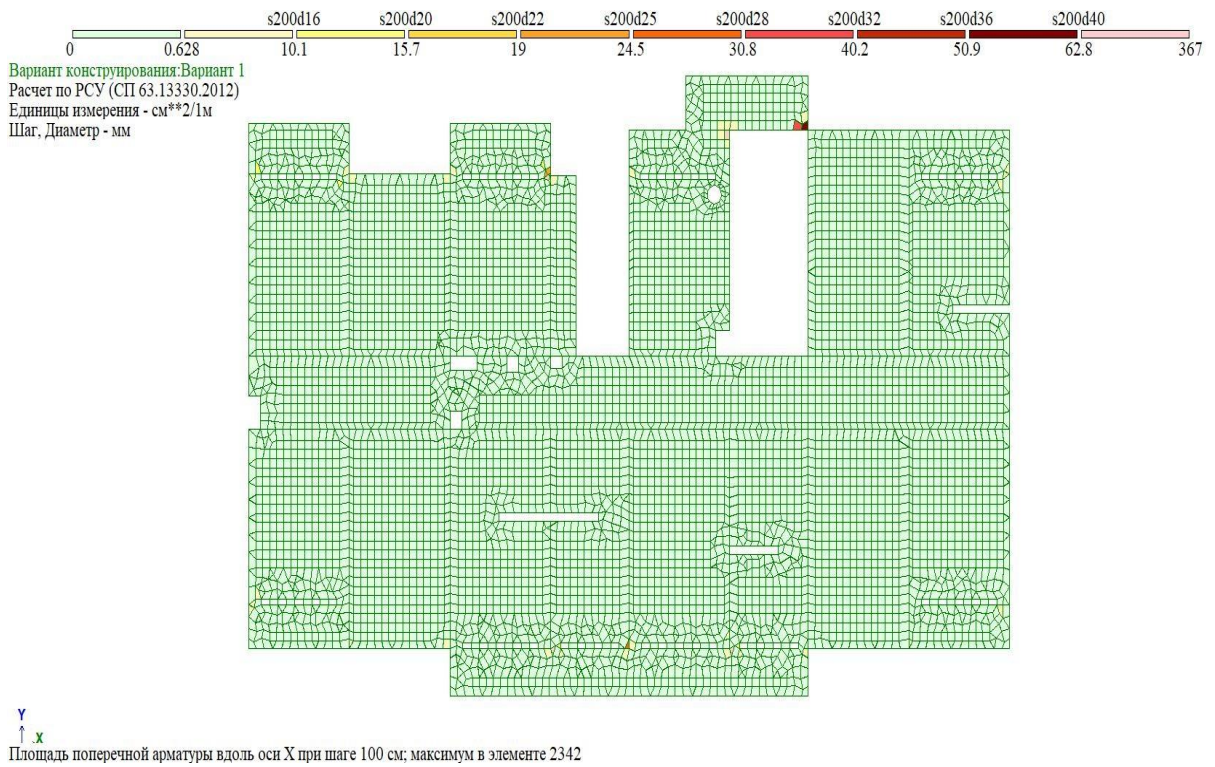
Плита перекрытия 3 этажа. Поперечное армирование по X.
